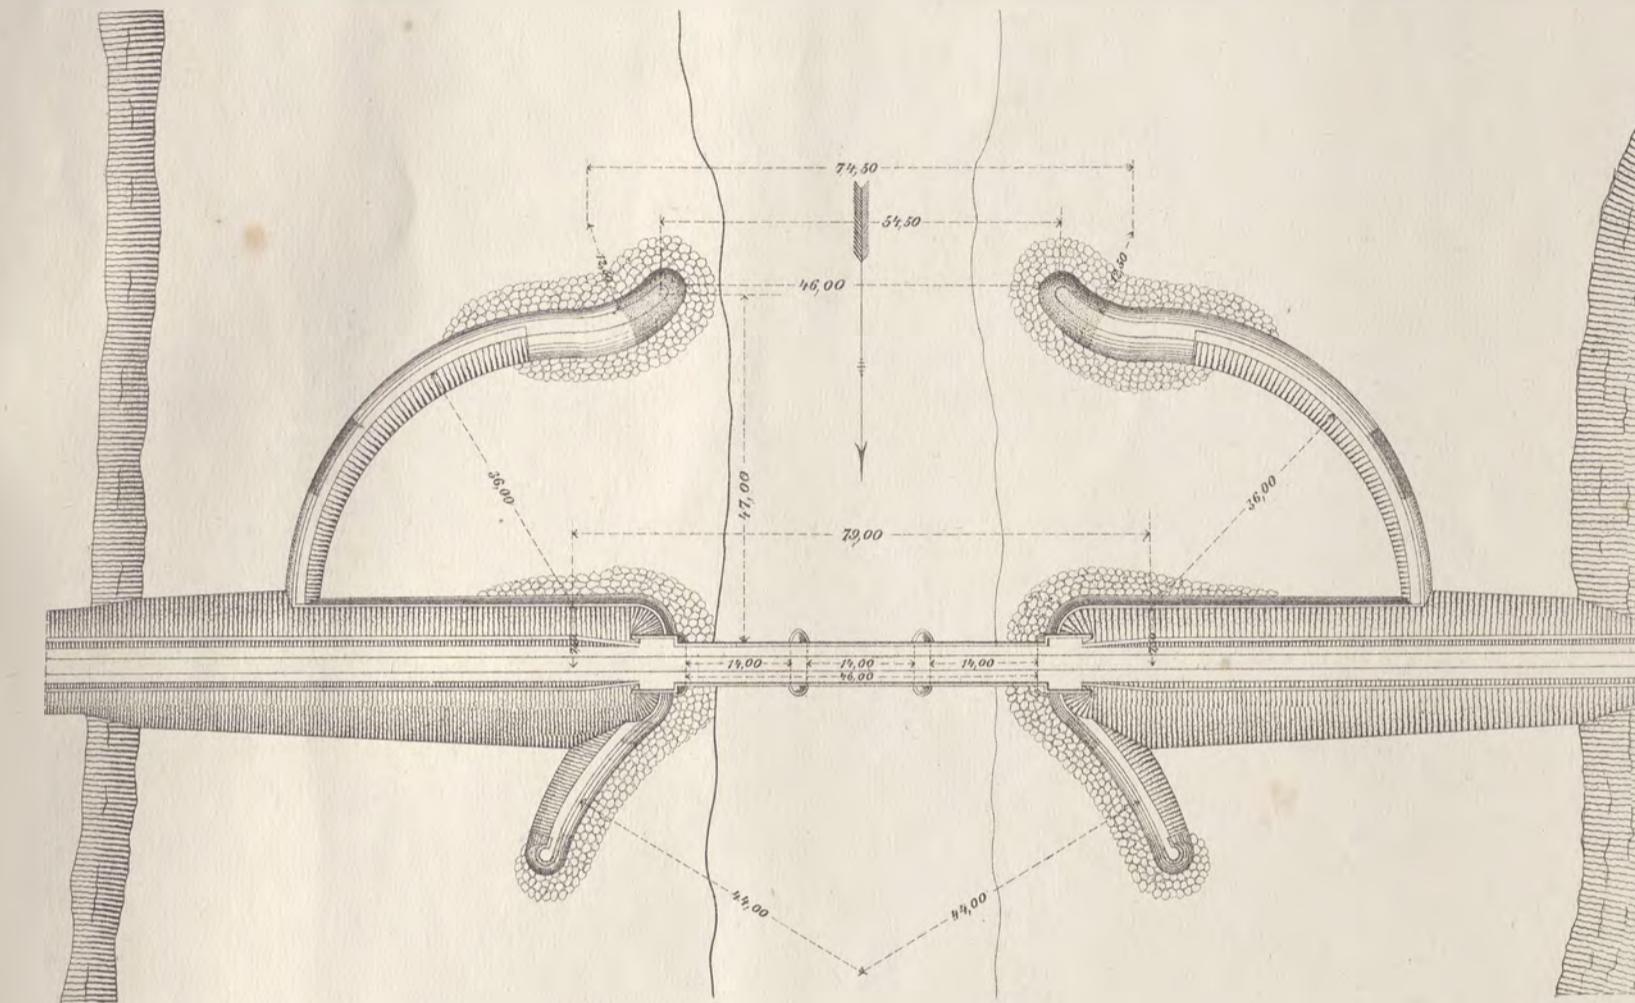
^a Proiezione orizzontale ed elevazione di un argine a monte.
